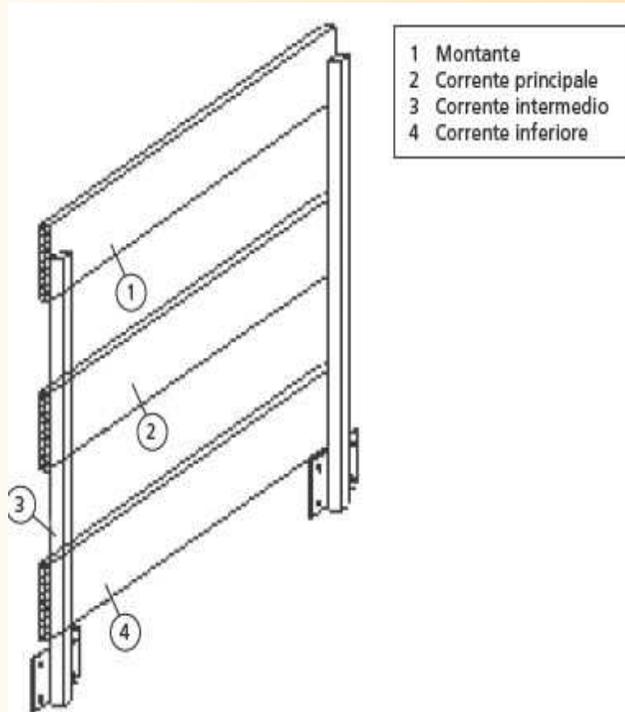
Parapetto provvisorio con corrente intermedio
